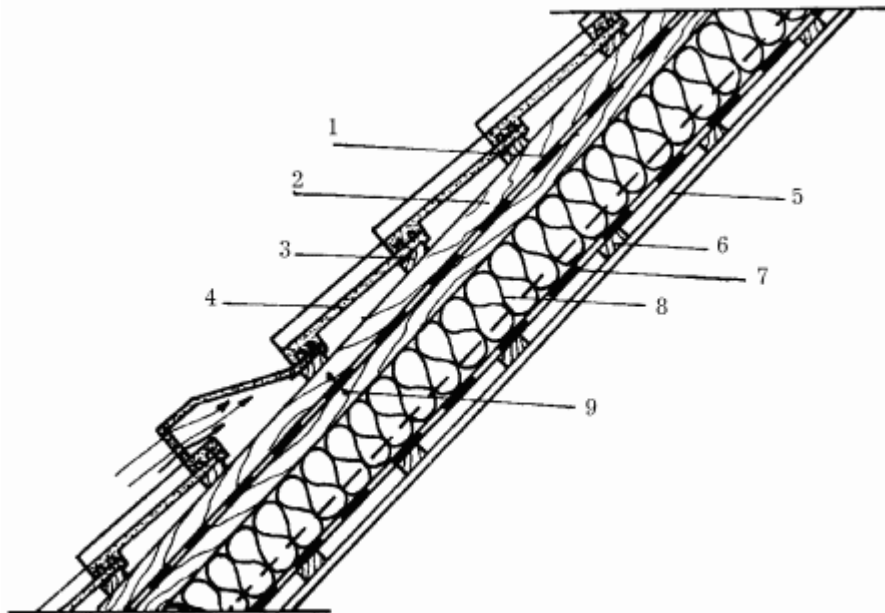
Конструкция крыши для мансарды с зимним садом: 1 – гидроизоляция; 2 – контрбрус; 3 – обрешетка; 4 – черепица; 5 – линсекартон; 6 – обрешетка; 7 – пароизоляция; 8 – теплоизоляция; 9 – вентиляция.
